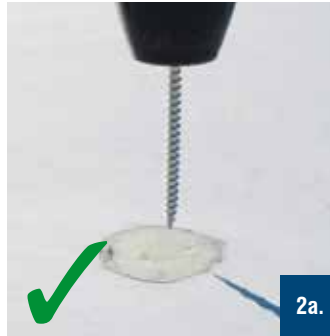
und 14: Detail – Anbohren der Kunststoffaussparung
